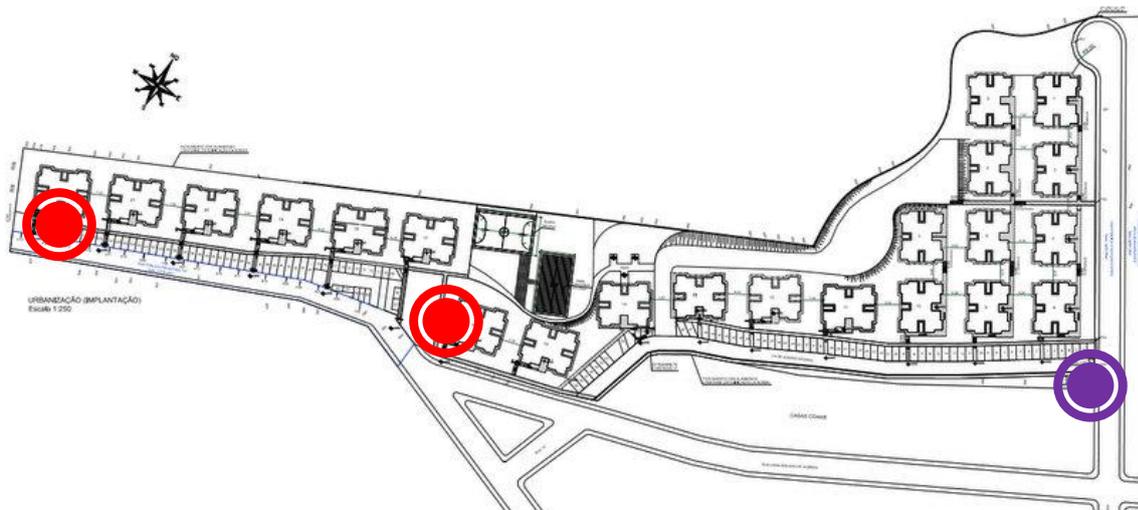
Planta de implantação do Conjunto, sendo o círculo em roxo o local da lixeira existente e os círculos em vermelho, os locais propostos para as novas (Fonte: a equipe - sem escala)
